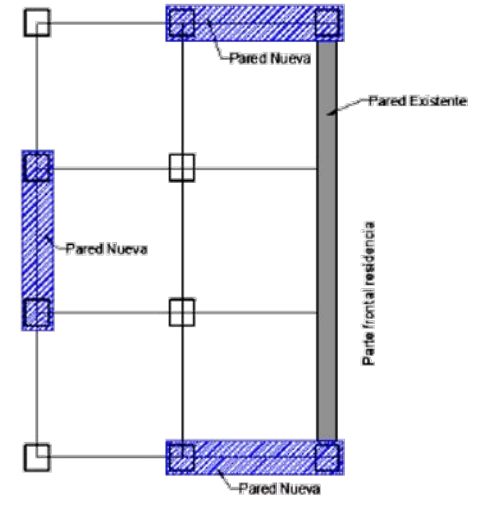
Vista en Planta de Casa en Zancos con Posible Localización de las Paredes Nuevas
